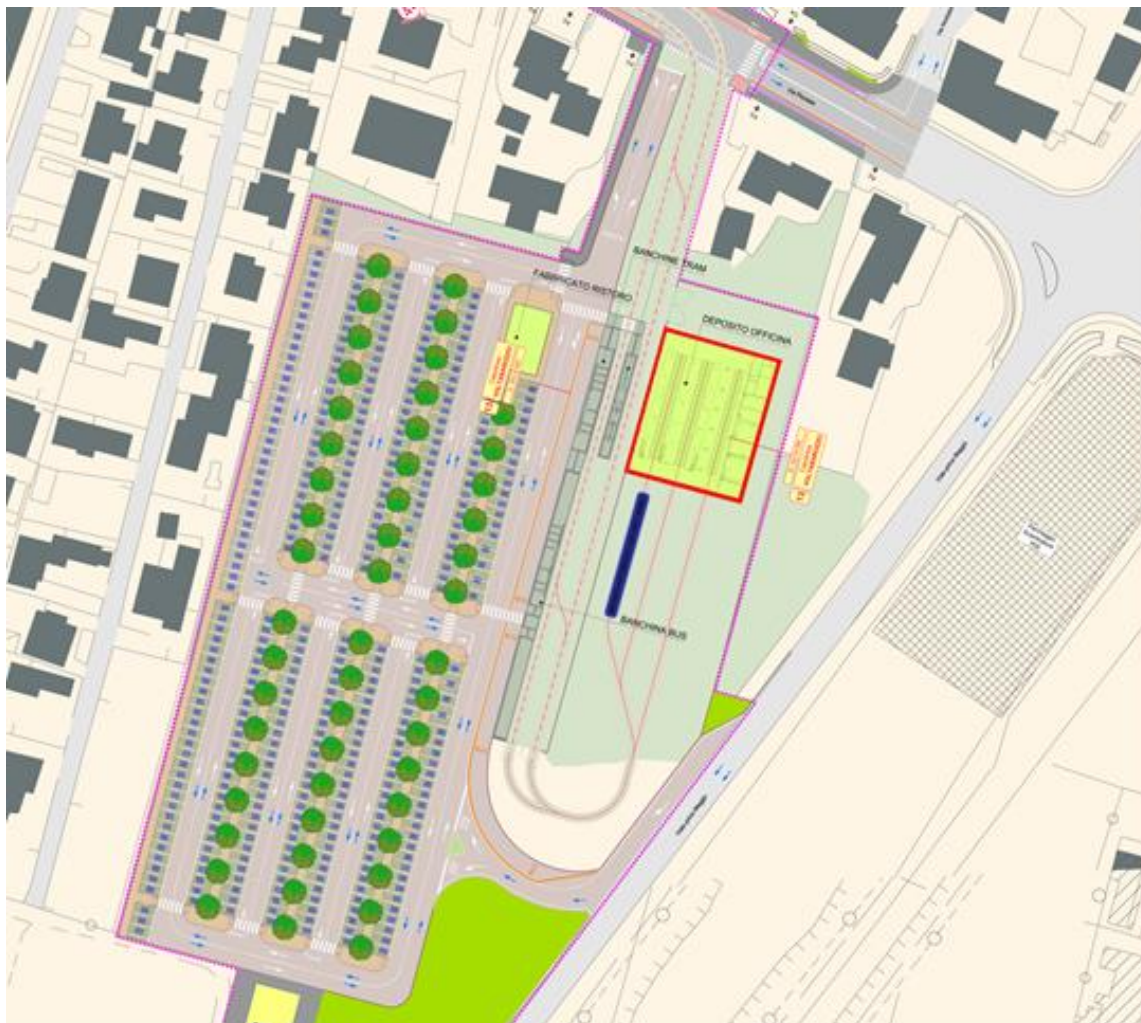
Planimetria di Progetto Deposito Voltabarozzo
